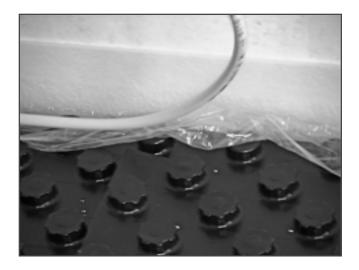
Particolare: fissaggio della bandella perimetrale mediante posa del tubo
